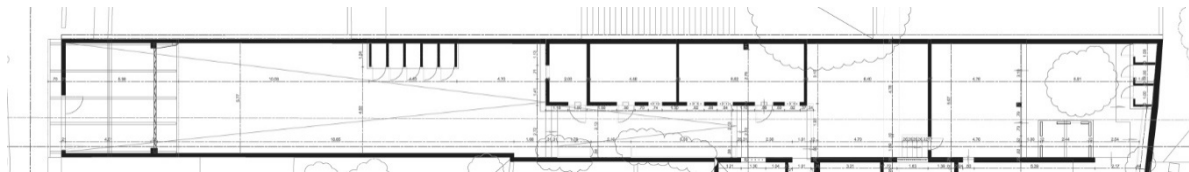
(Planta de levantamiento costado sur, fuente propia ,2018)
